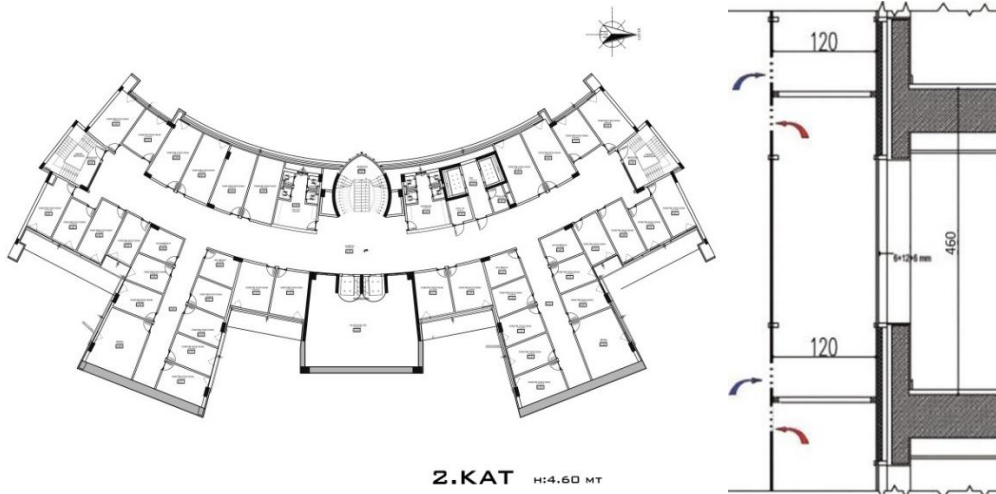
Plan şeması ve kat seviyesinde kısmi şematik kesiti
